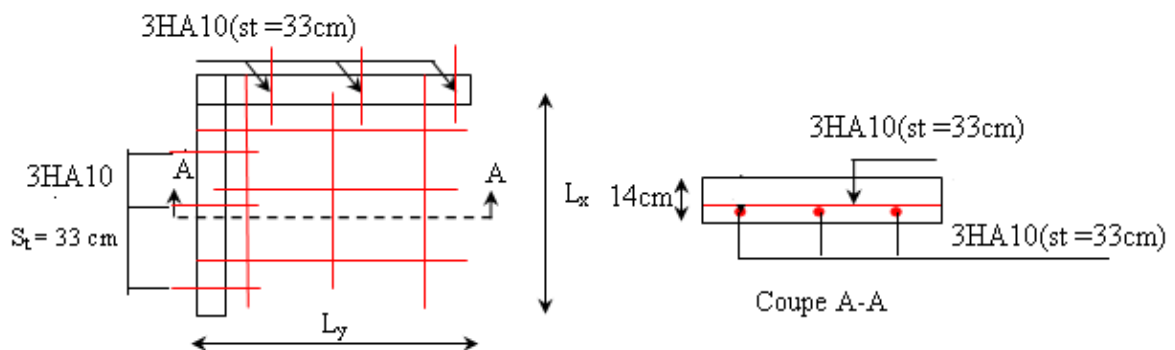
Schéma de ferrailage de la dalle D1, D4.
